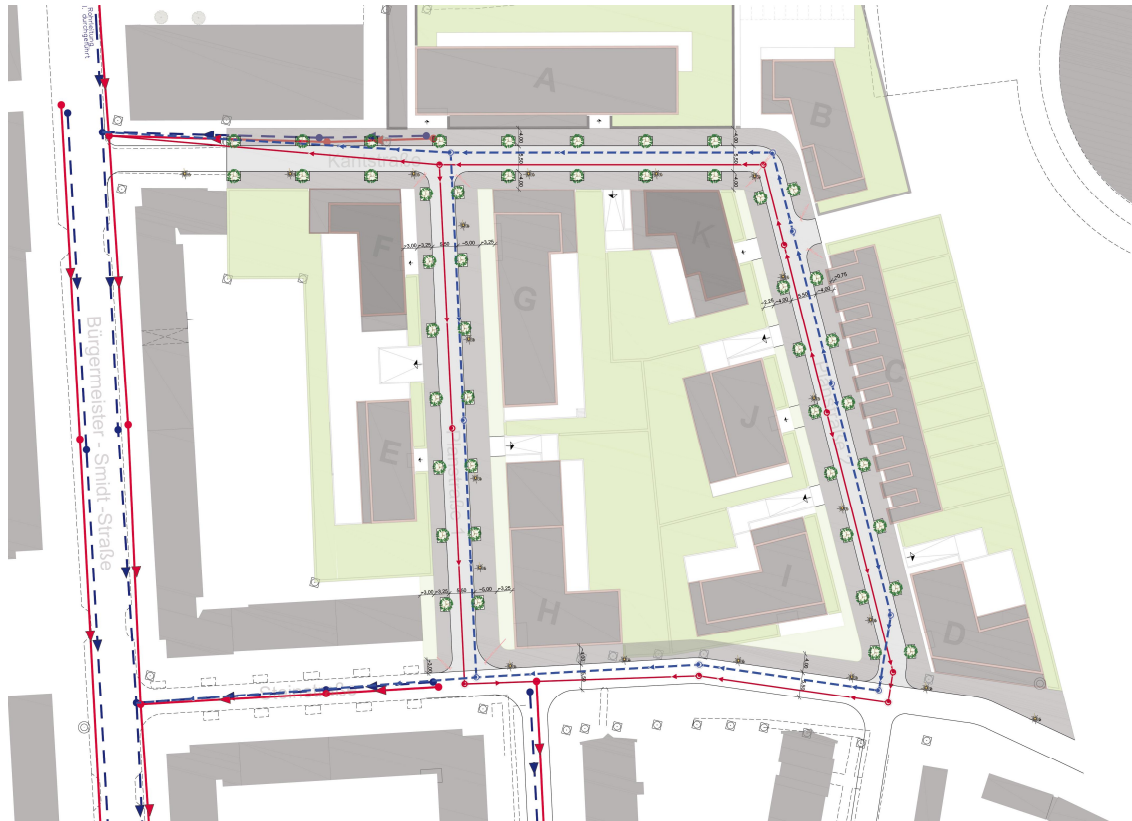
Gestaltungsplan des Straßenraumes mit Standorten der zu pflanzenden Straßenbäume, Planungsbüro Gerdes, Stand: 05.10.2016, o.M.
